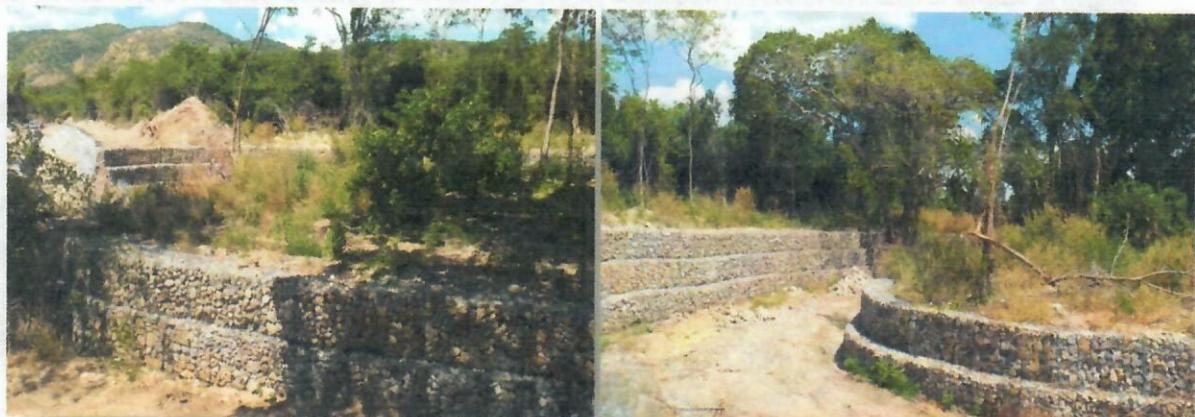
Material forestal intervenido por maquinaria para la construcción de gaviones, punto 6, Arroyo Pozo Hondo
